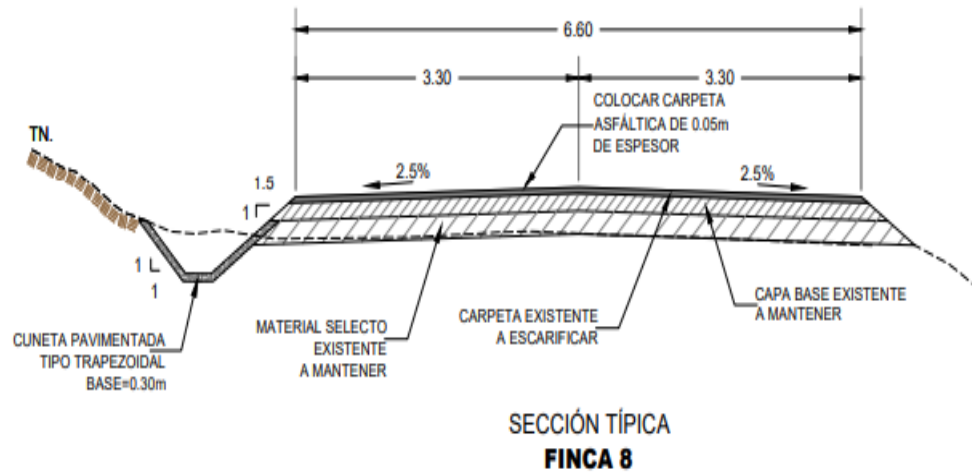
Sección típica Finca 8. Fuente: Planos del proyecto
